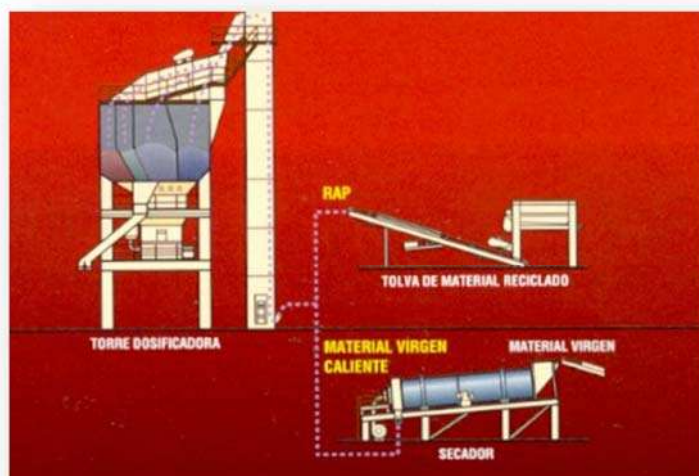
Planta discontinua con ingreso de RAP en elevador caliente.
